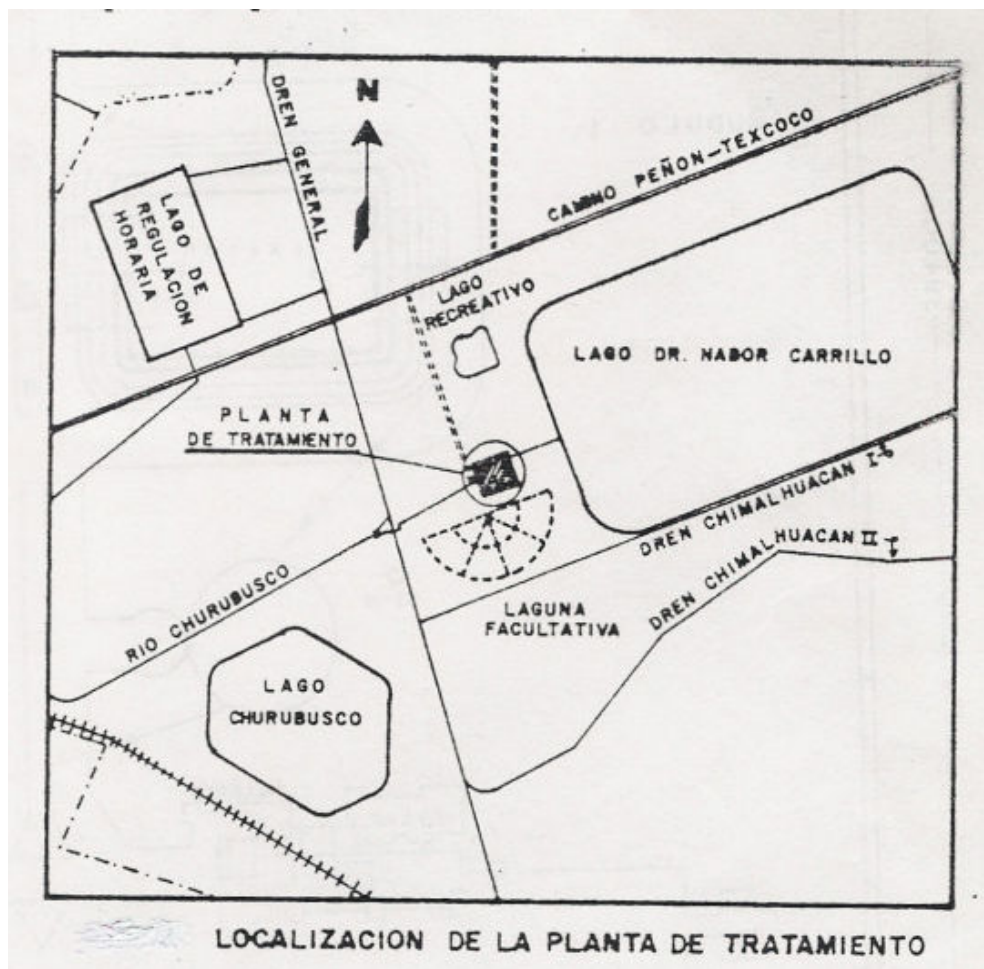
Ubicación de la planta de tratamiento en el proyecto Texcoco
